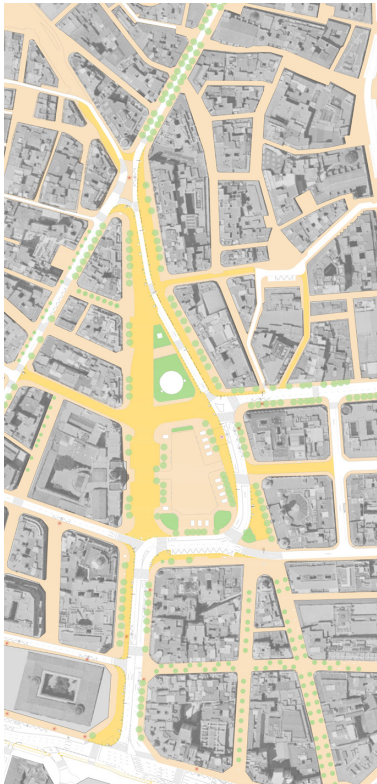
Planta de la actuación en la Plaza del Ayuntamiento.
